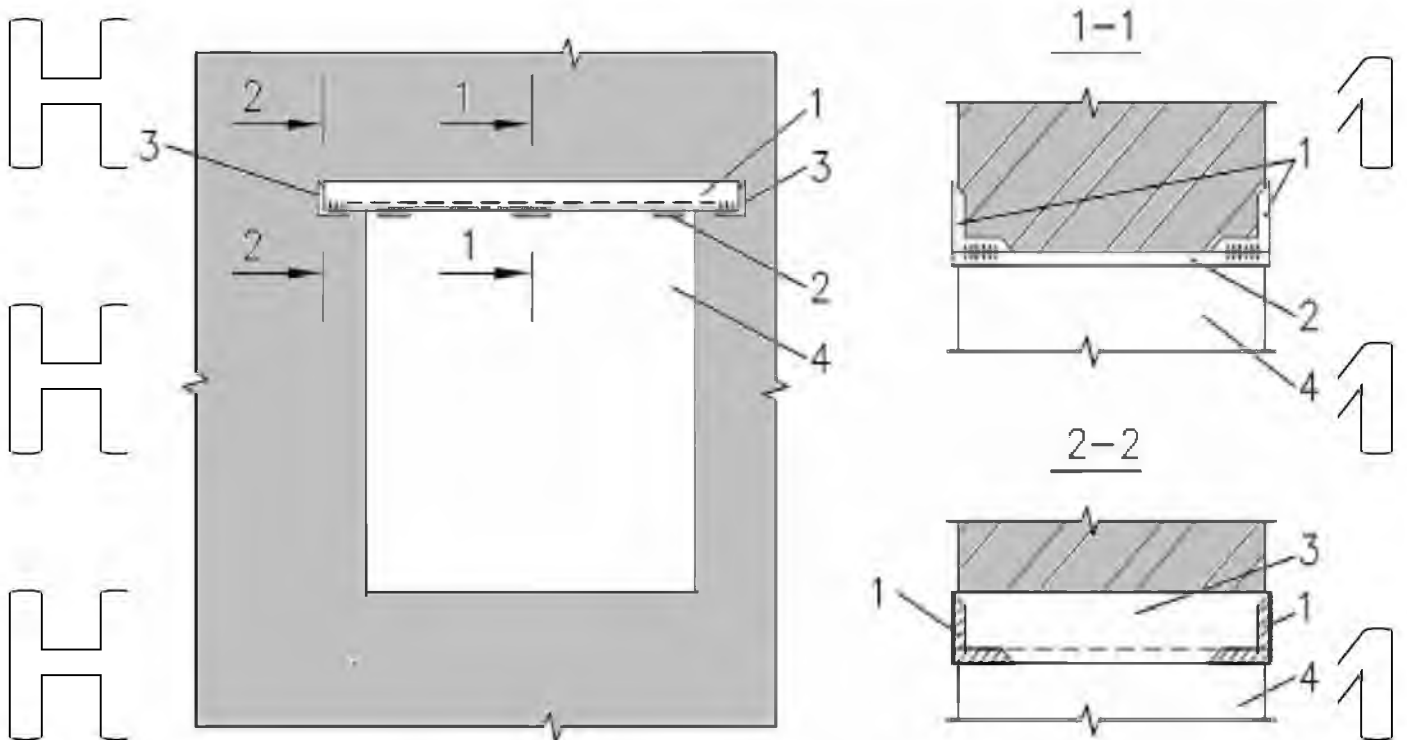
Посилення плоских перемичок накладками: 1 – повздовжні кутики; 2 – поперечні планки; 3 – торцеві кутики; 4 – проїом
